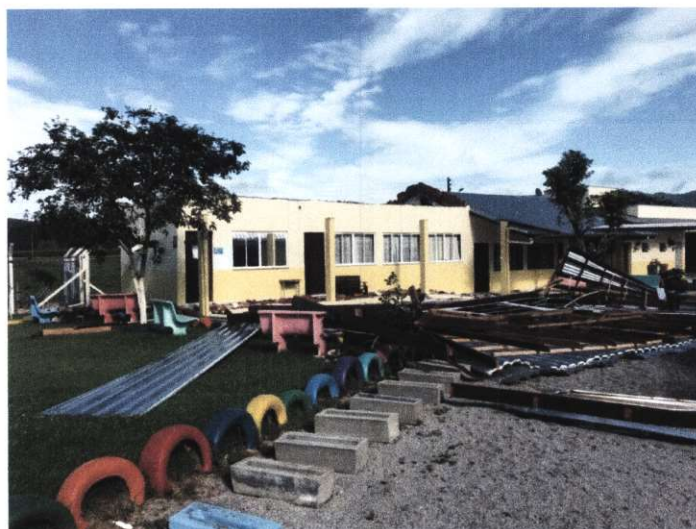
Destroços espalhados pelo terreno – Fonte: Autor 2020
